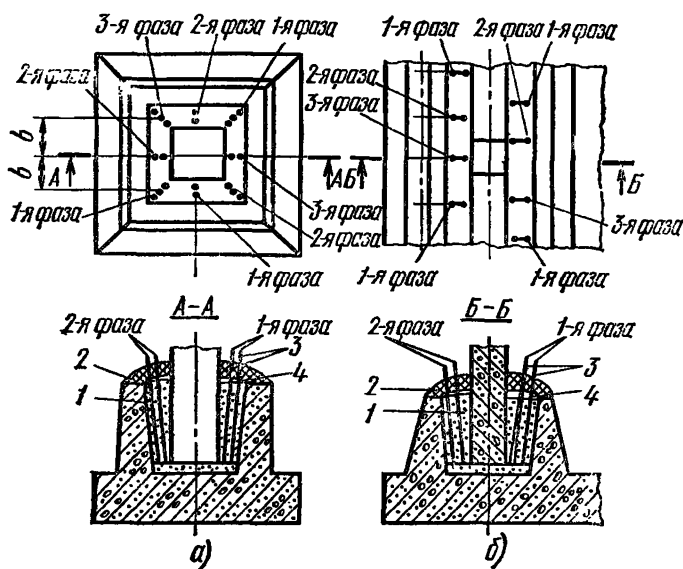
Электропрогрев бетона стыков колонн с фундаментами стаканного типа (а) и стеновых панелей в пазах опорных плит (б):
